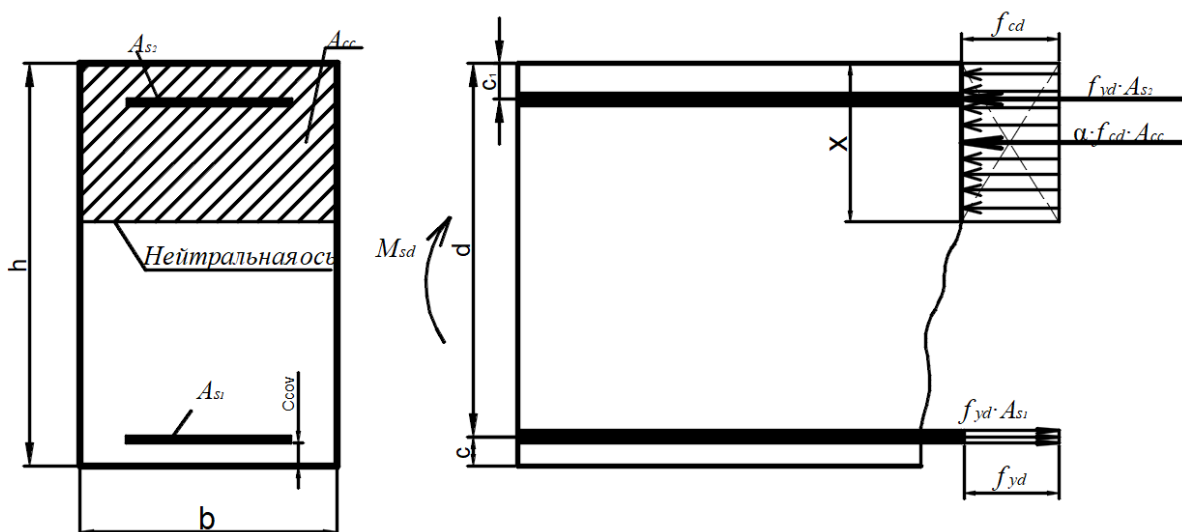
Расчетное предельное состояние прямоугольного сечения с двойной арматурой
